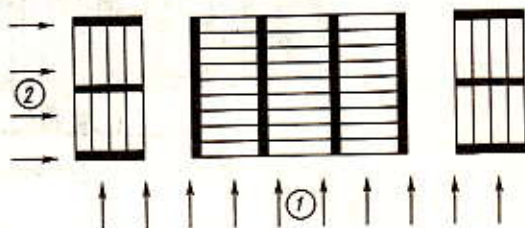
План несущих стен зданий, рухнувших при землетрясении 1988 г. в Армении
